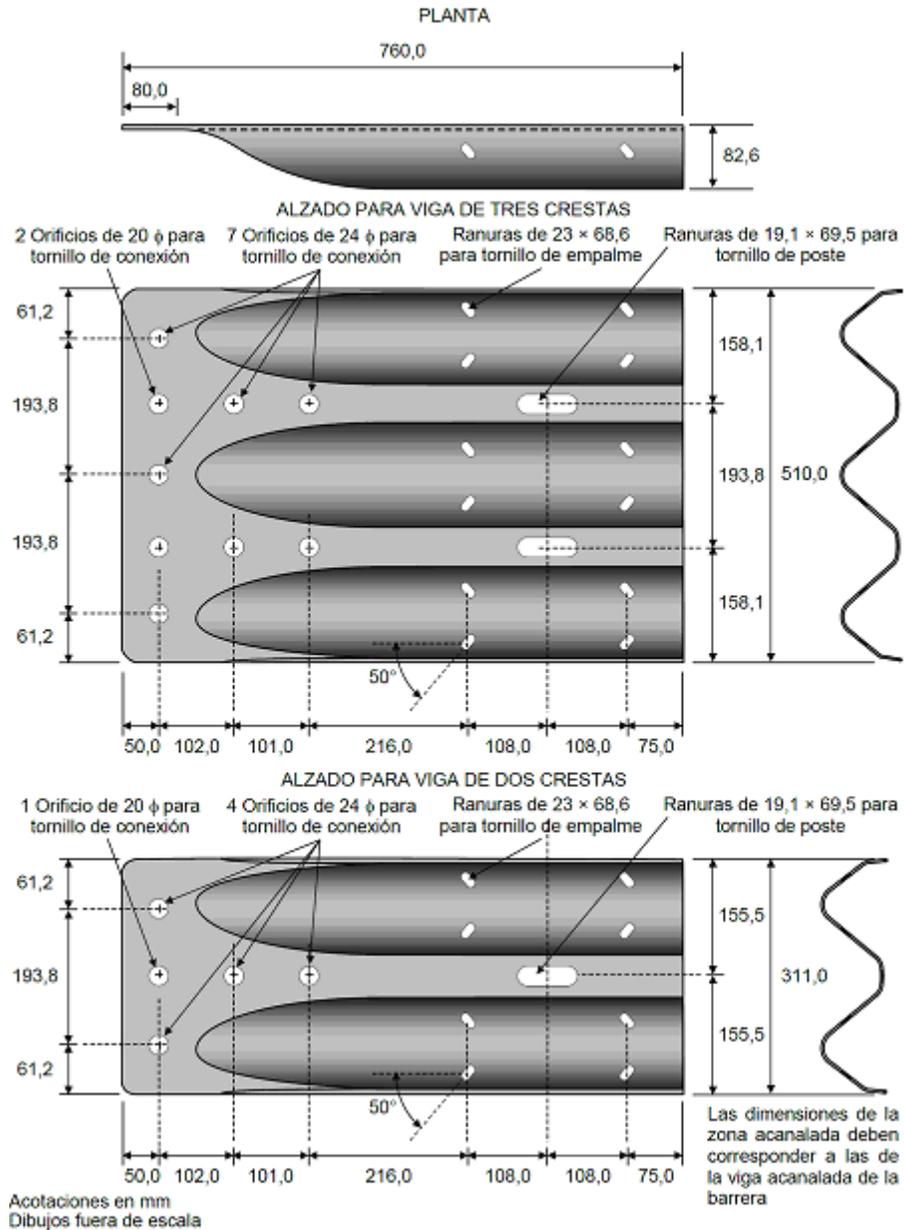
Zapatas de conexión para barreras de vigas acanaladas de acero
